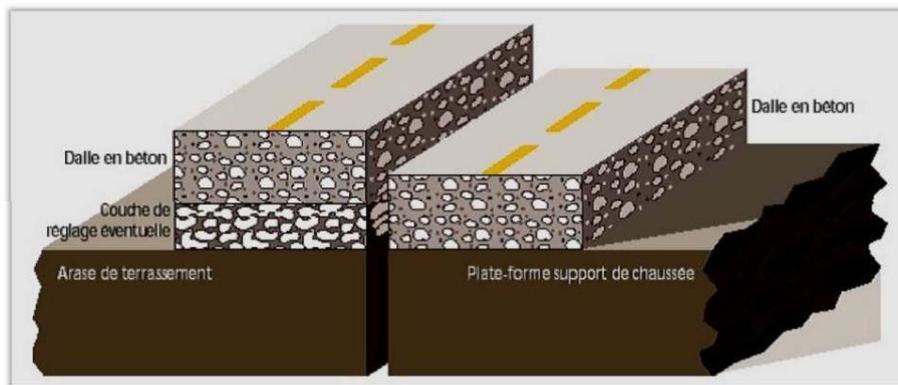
STRUCTURE TYPE D'UNE CHAUSSEE RIGIDE
